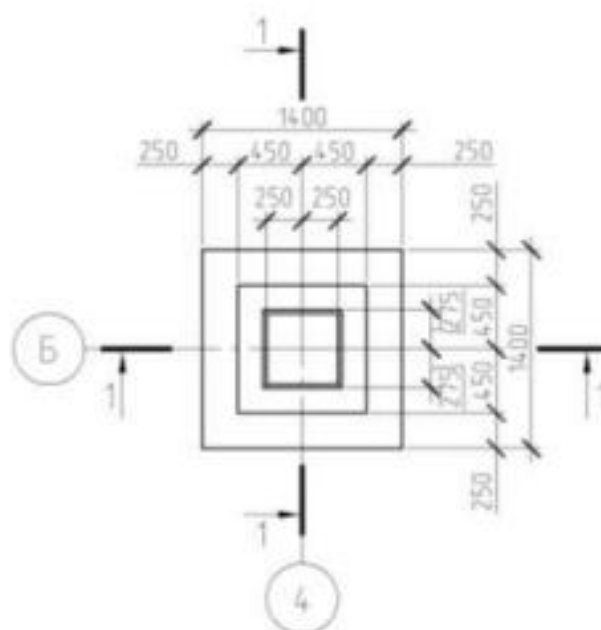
Пример оформления плана ростверка отдельного свайного фундамента
